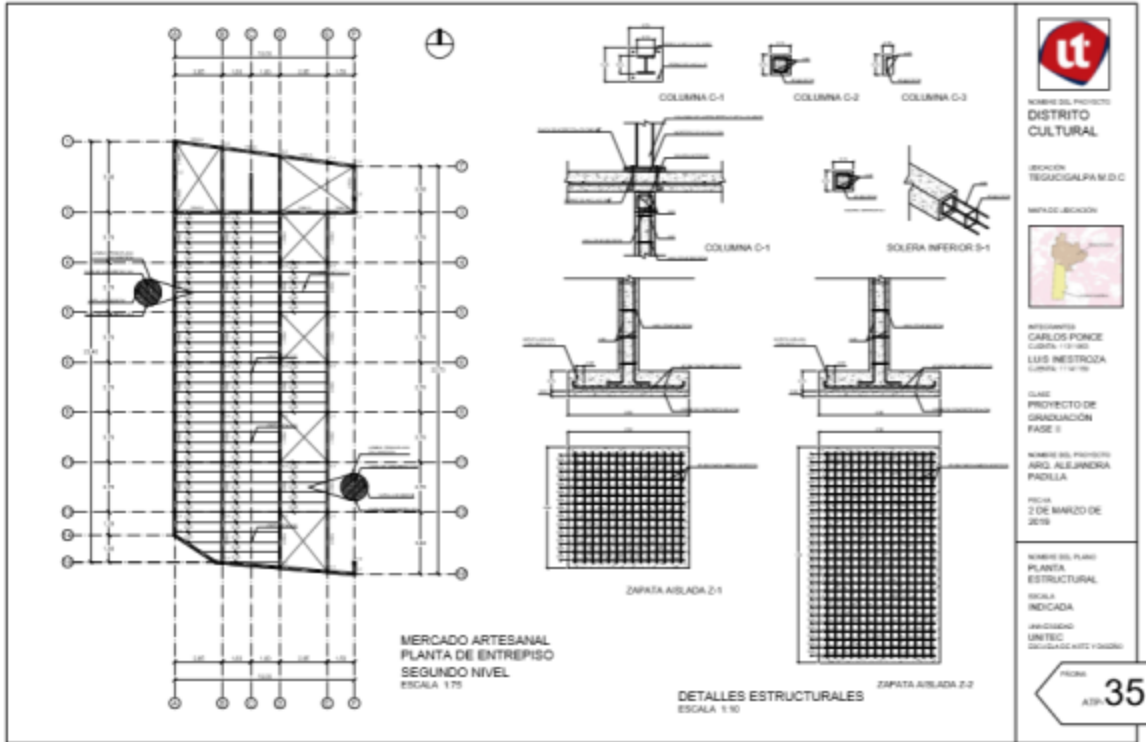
Planta de Entrepiso y Detalles Mercado Artesanal
